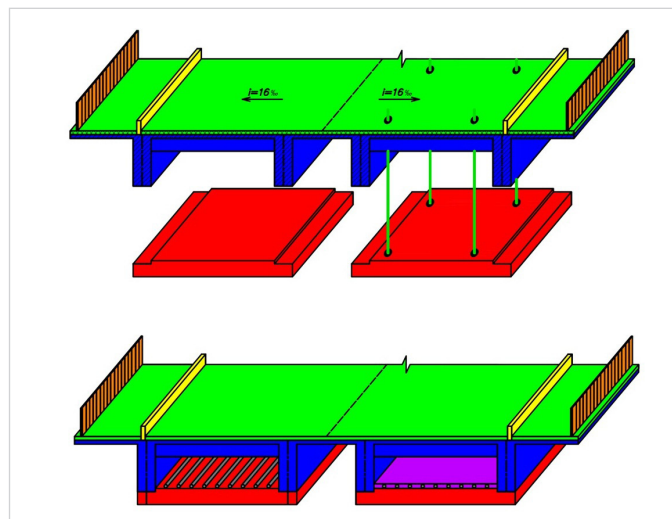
Установка нижней плиты, пучков преднапряженной арматуры по нижней плите и обетонирование их фибробетоном
